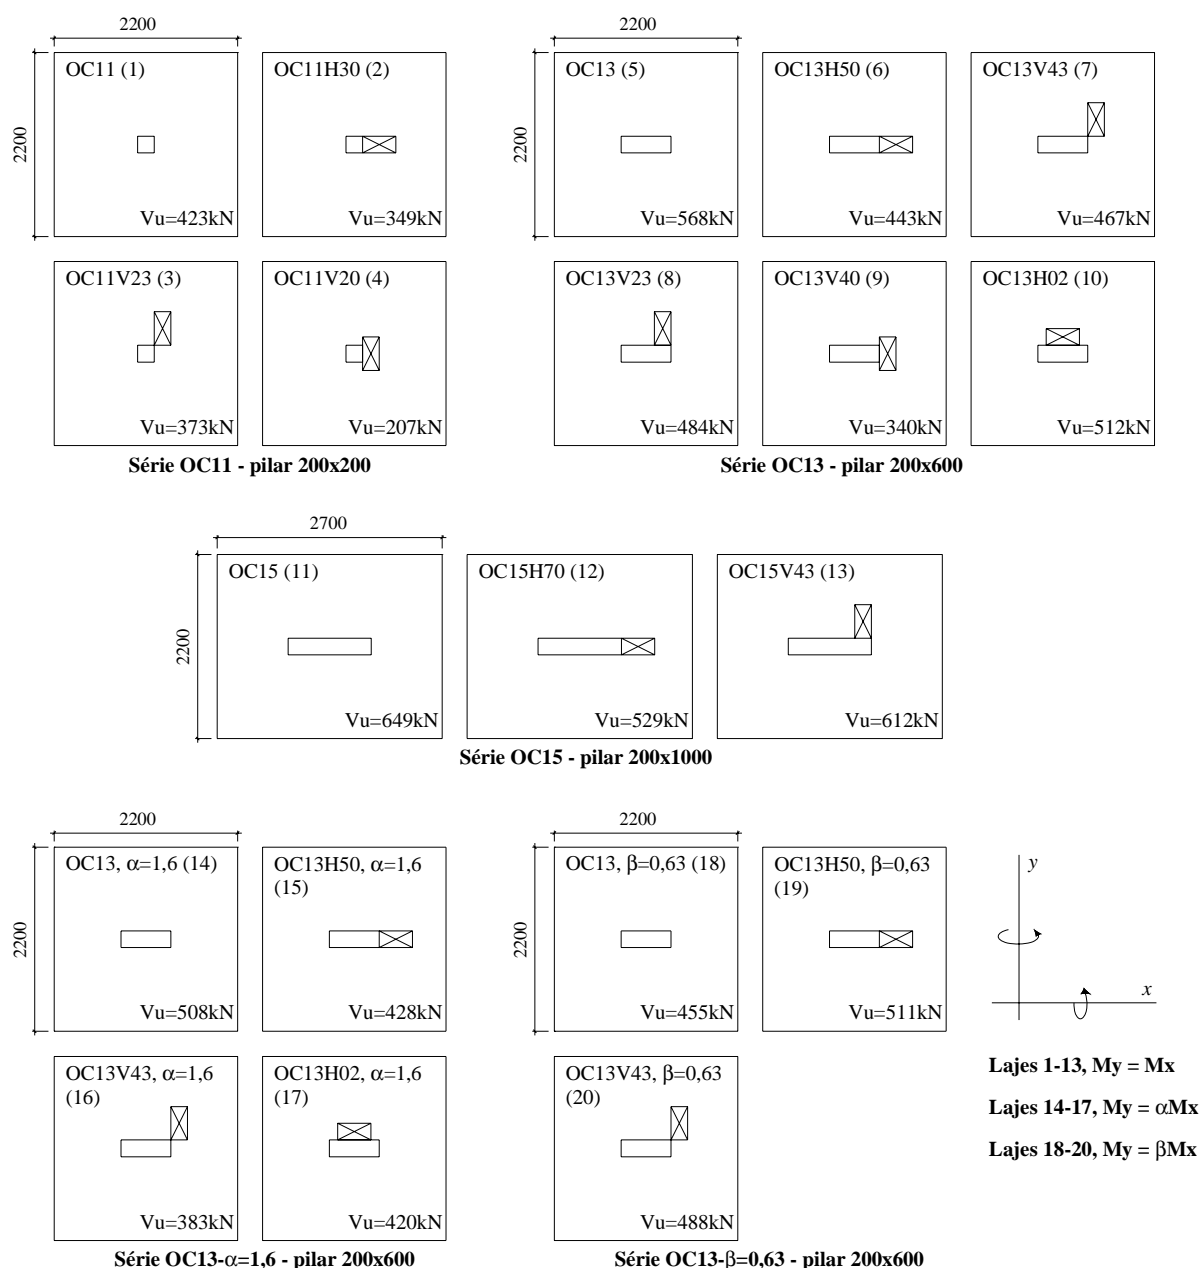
Características principais e cargas últimas das lajes de TENG et al. (mm)
